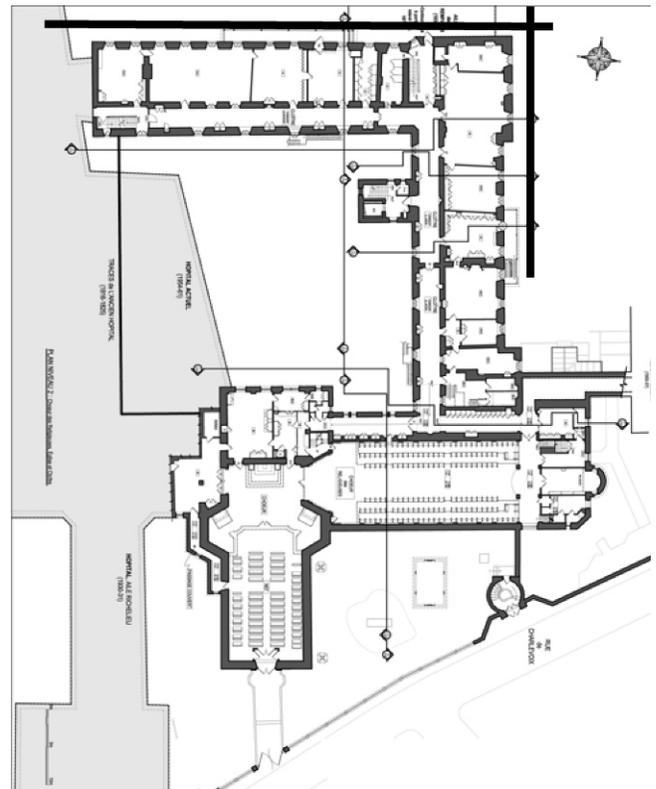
La division cadastrale sur le plan des bâtiments et du site en 1848
